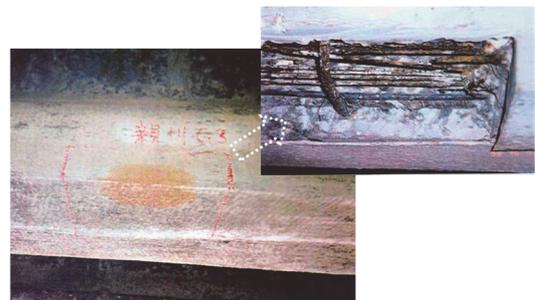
鋼材腐食が外観変状に現れずコンクリート内部で損傷が進行している例
